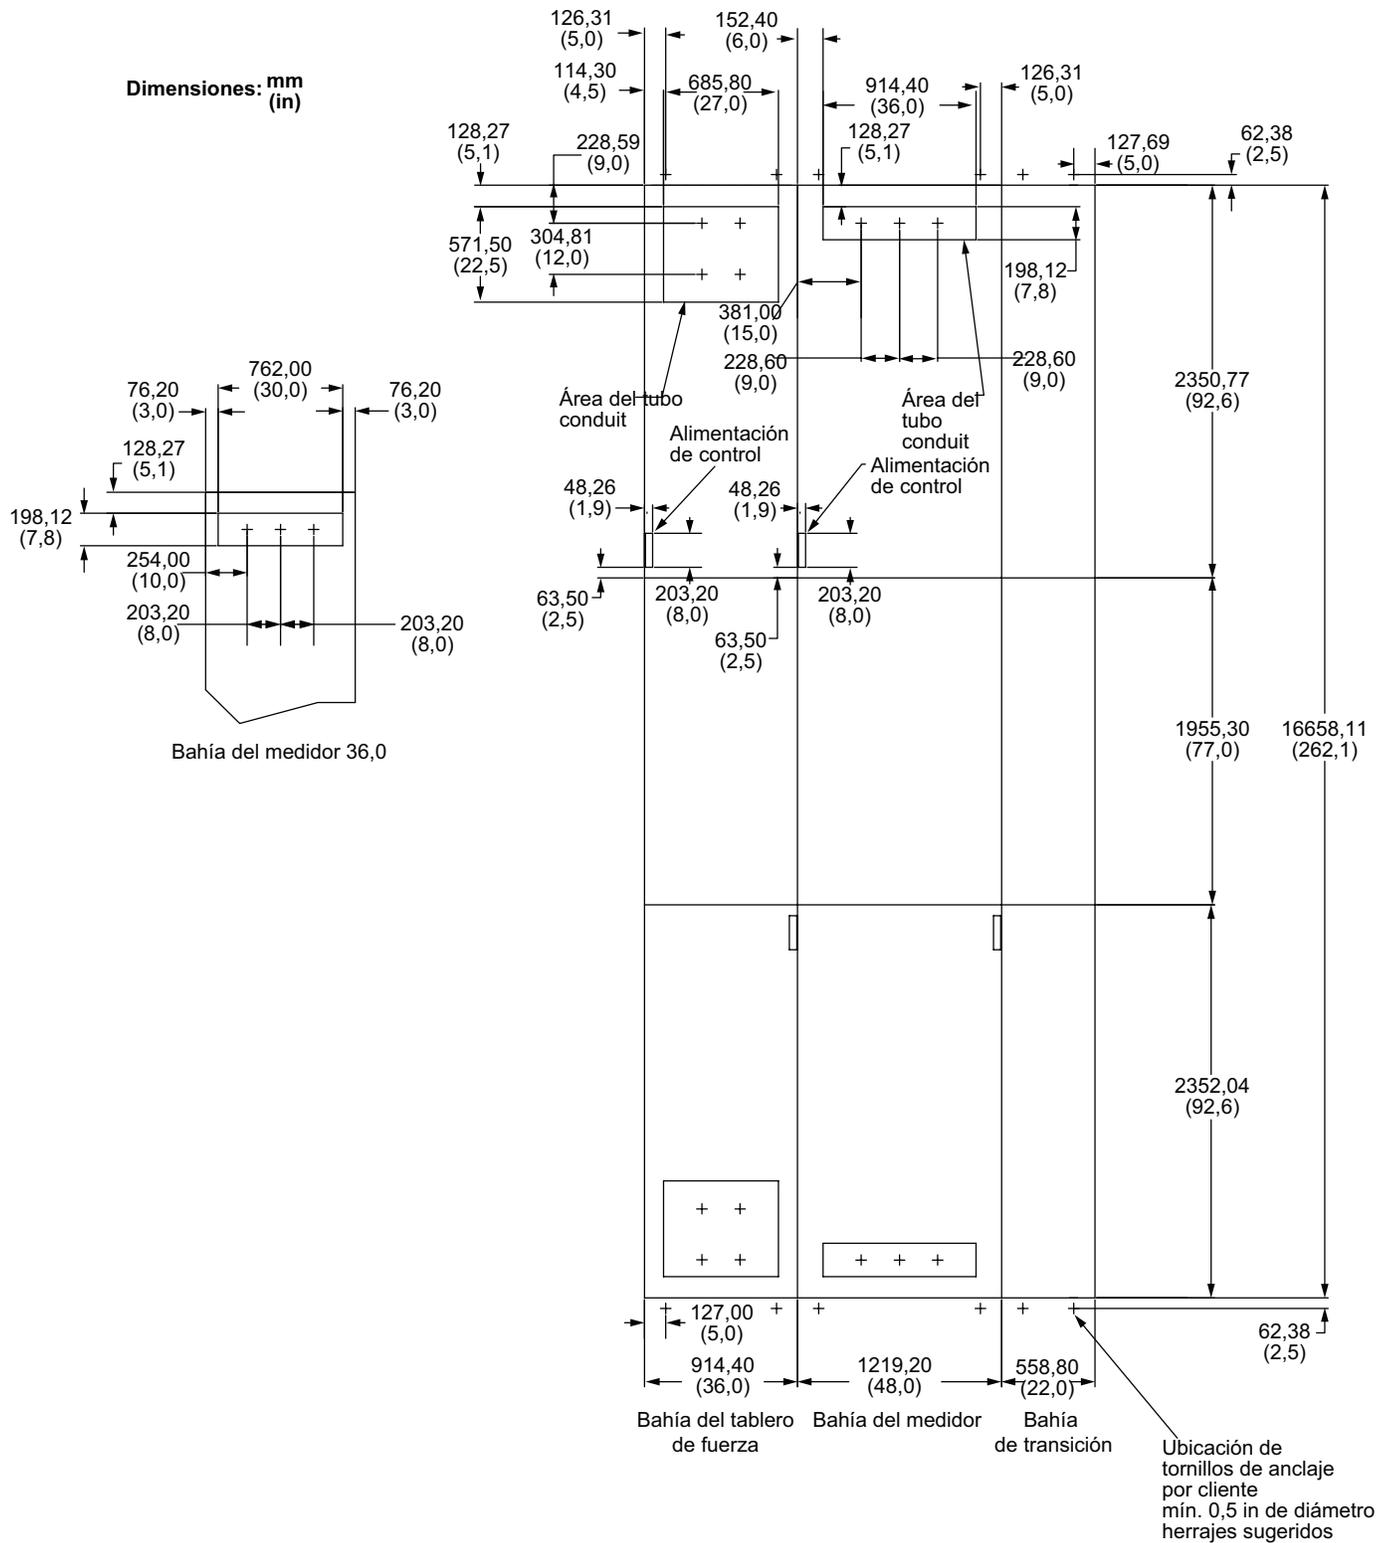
Plano típico de planta de pasillo común (no para construcción)
